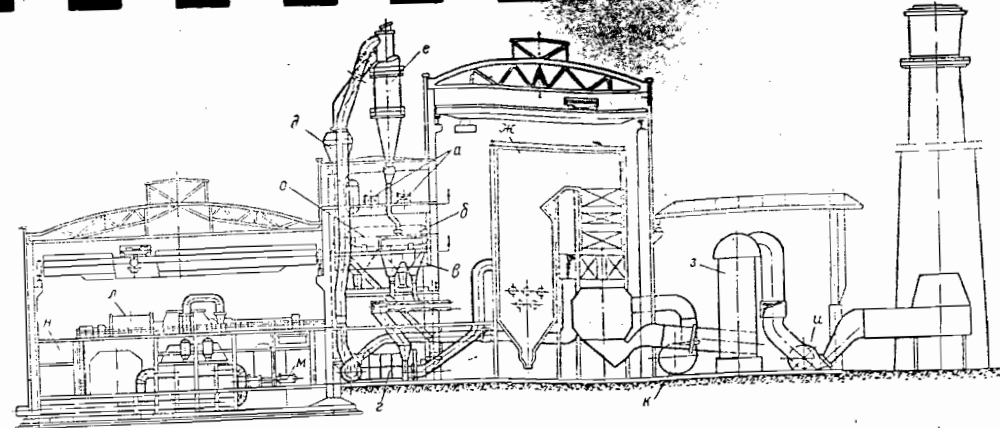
Поперечный разрез и план главного корпуса ГРЭС 1200 Мвт. а — транспортеры топливopдачи; б — бункер сырого угля; в — бункер пыли; г — барабанная шаровая мельница; д — сепаратор пыли; ж — котлоагрегат; з — золоуловитель; и — дымосос; к — дутьевой вентилятор; л — турбоагрегат; м — питательный насос; н — пылевой циклон; о — распределительное устройство собственных нужд; п — деаэратор.
